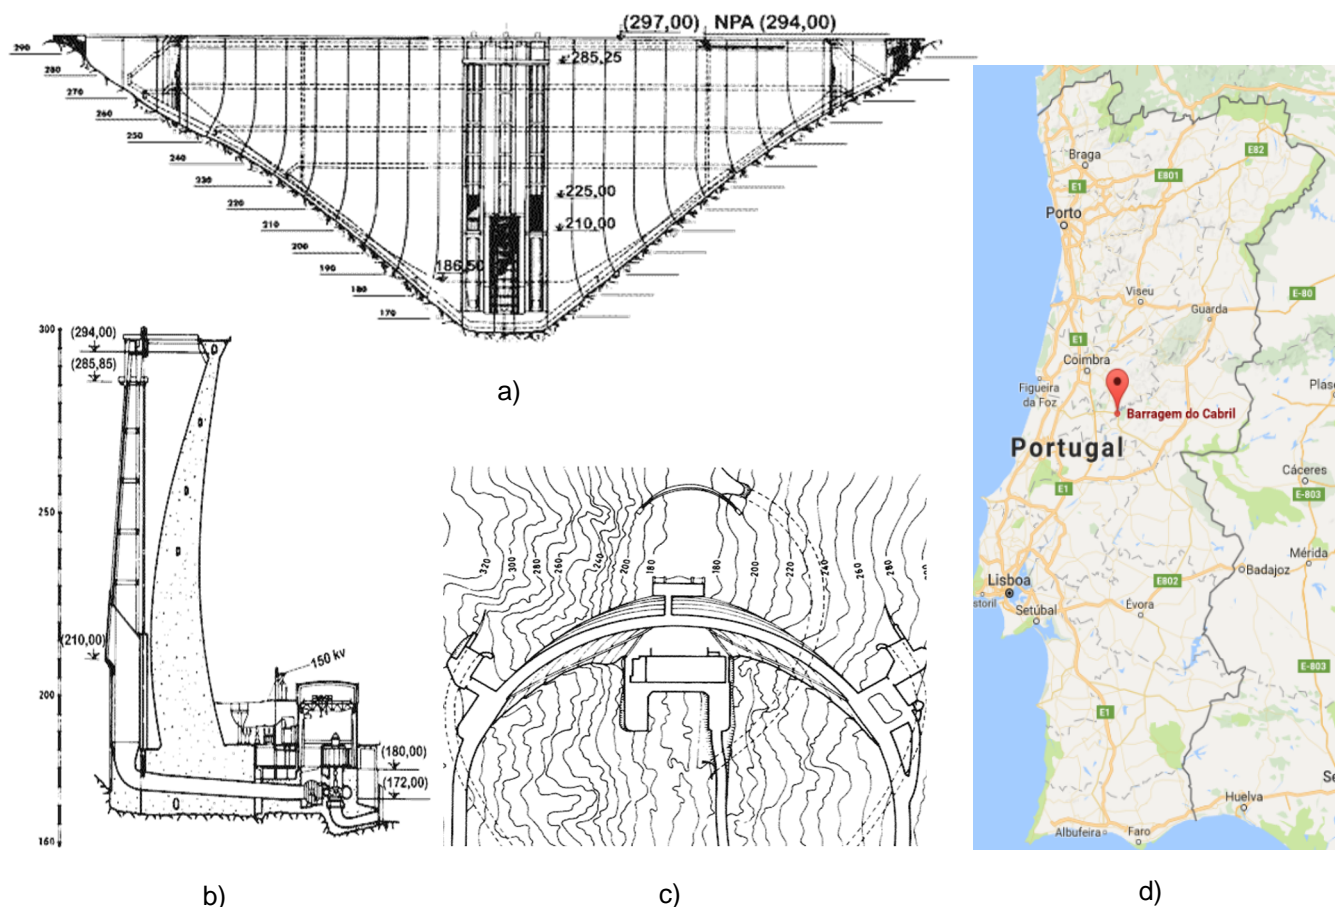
Barragem do Cabril (CNPGB, 2017); a) Vista de montante (alçado planificado); b) Vista de perfil; c) Planta; d) Localização geográfica da barragem do Cabril.
